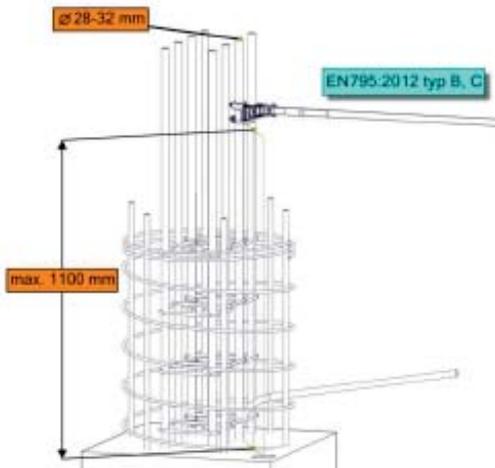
Installation von horizontalen Anschlagseilen in Verbindung mit dem Anschlagpunkt A-165
